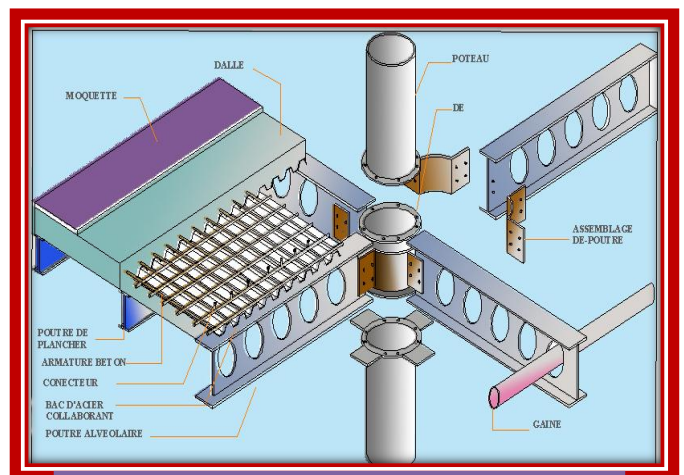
Schéma représentant le détail de jonction poteau - poutre - plancher
